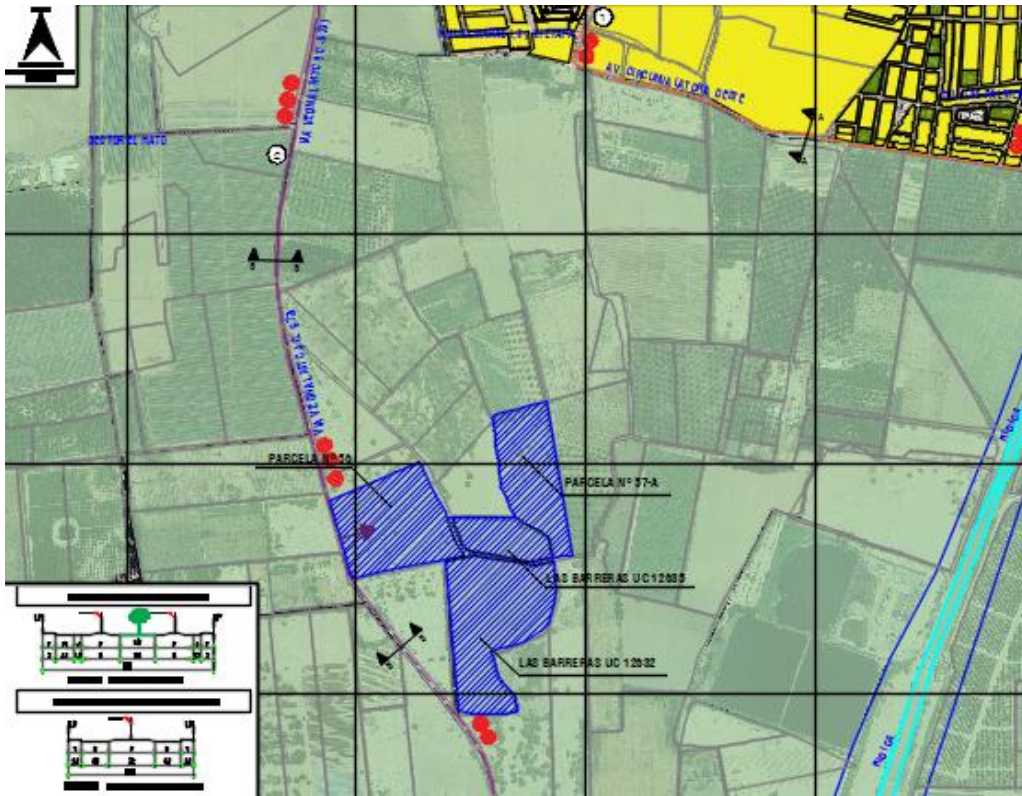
Plano vías y Transporte, ver plano PI – 15
